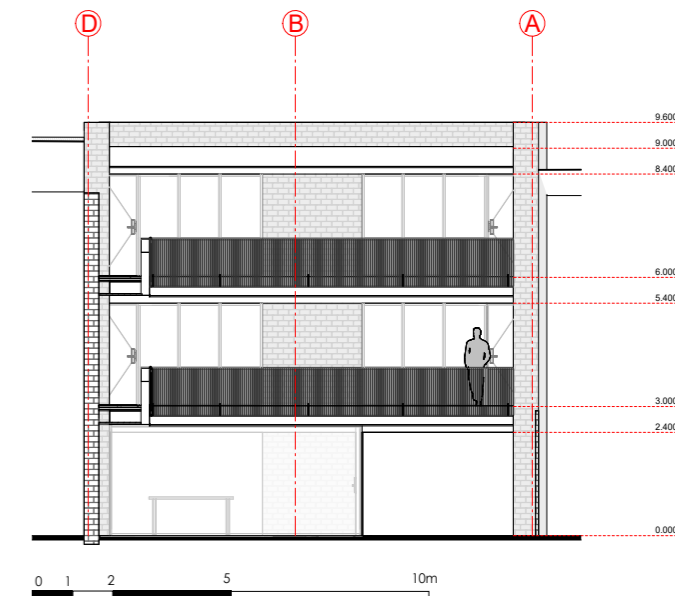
Sección transversal bloque lateral (ST-02). Fuente: Elaboración propia.
